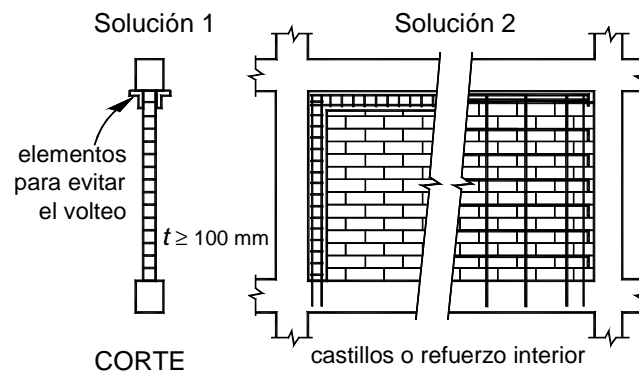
Detallado de muros diafragma (GDF, 2002)
